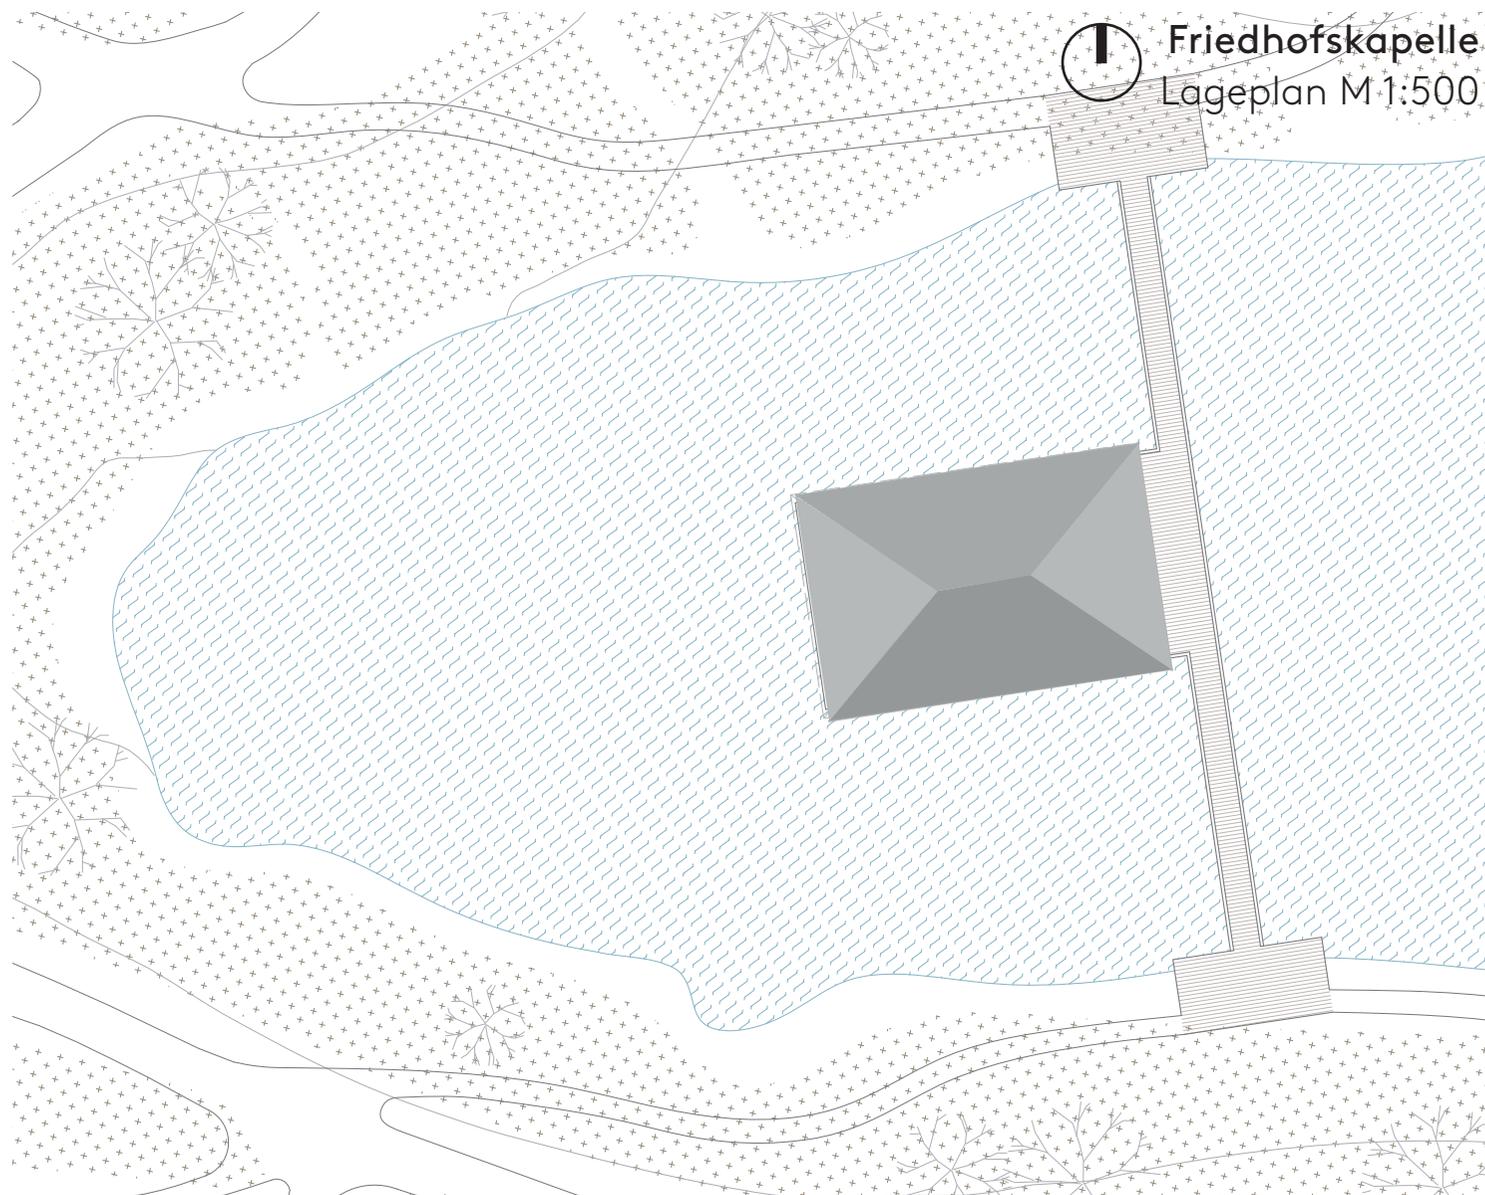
Wasserkapelle Lageplan M 1:500 (Táňa Kubiková 2017)
